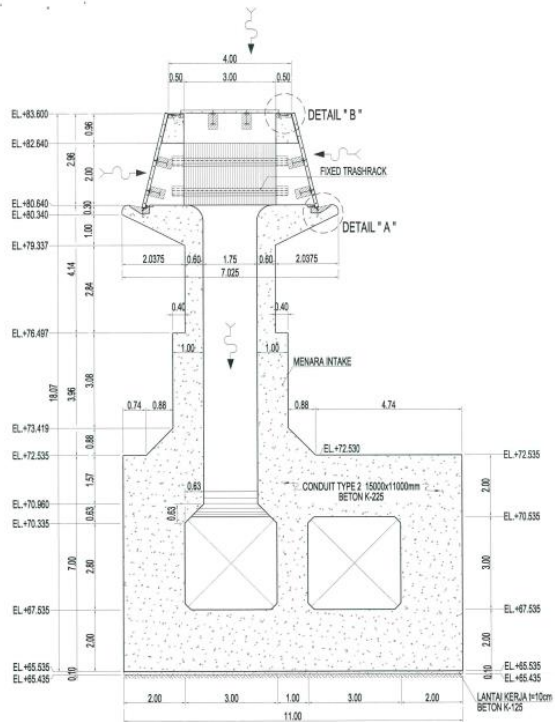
6 Denah Menara Intake dan Conduit/Bangunan Pengelak
